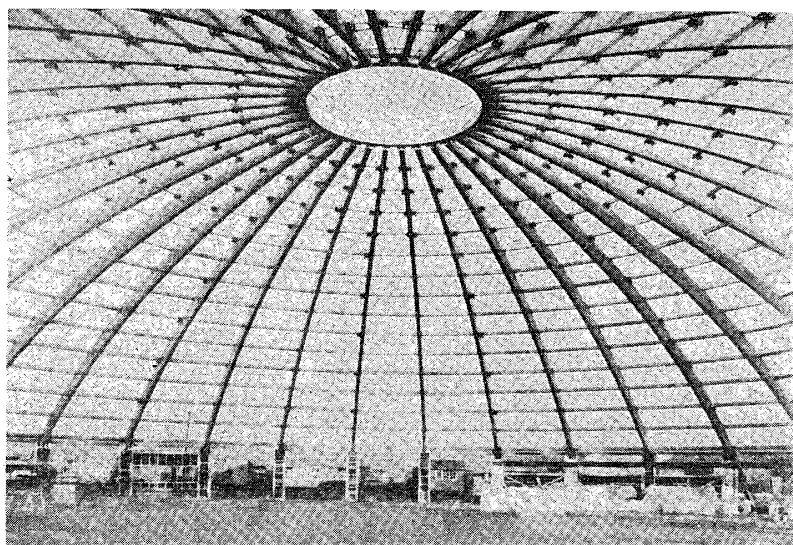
集成材リブよりなるドームタイプのスポーツセンター、リブは white wood
